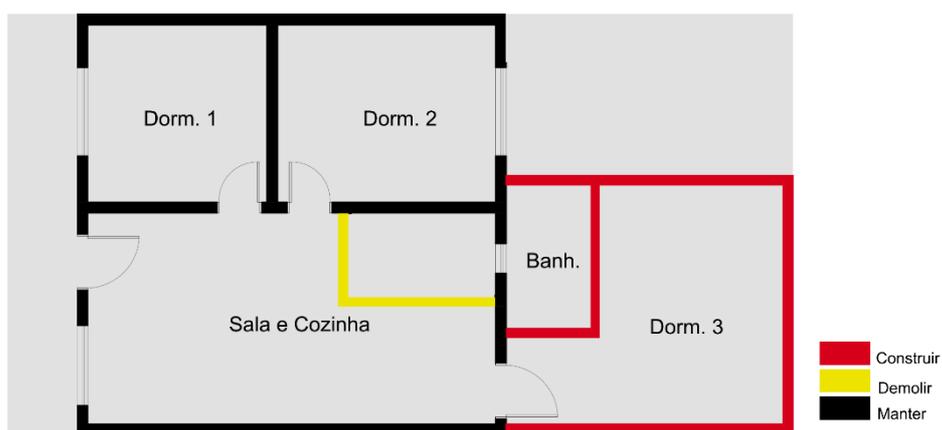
Planta Baixa Construir/Demolir. Fonte: Autor, 2023
